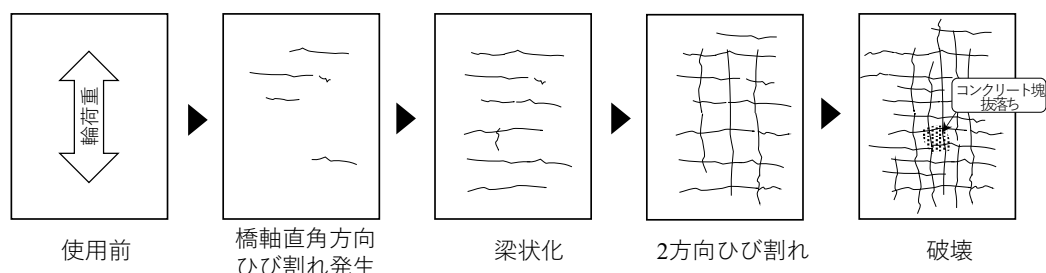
道路橋 RC 床版のひび割れ進展過程
